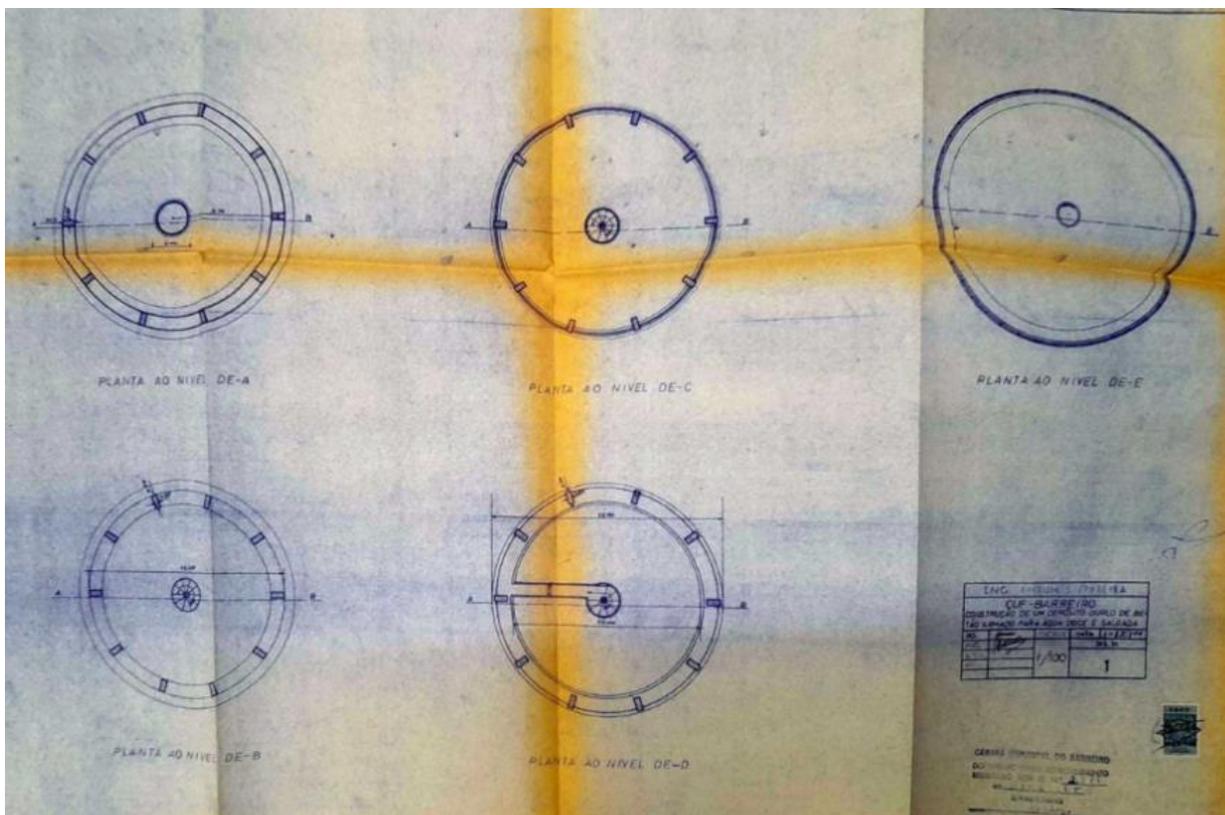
Conjunto de Plantas do Depósito Duplo de Betão Armado para Água Doce e Salgada que a CUF construiu no Bairro Operário.
